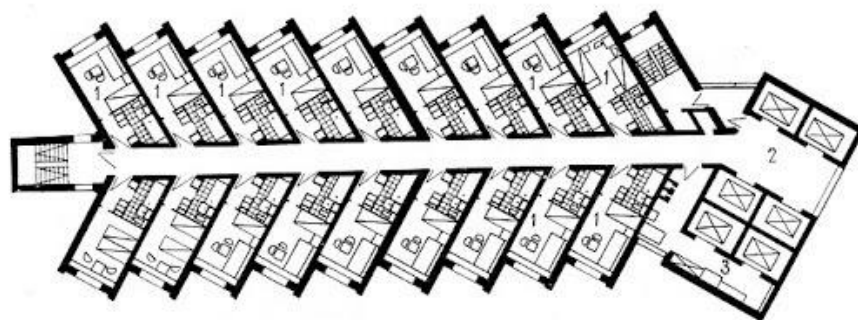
План житлового поверху готелю «Конгрес» (Карл-Маркс-Штадт, Німеччина)
